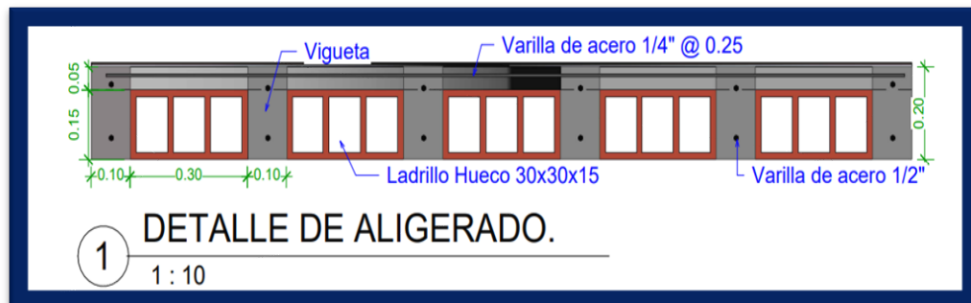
Detalle de losa aligerada del proyecto estructural.
